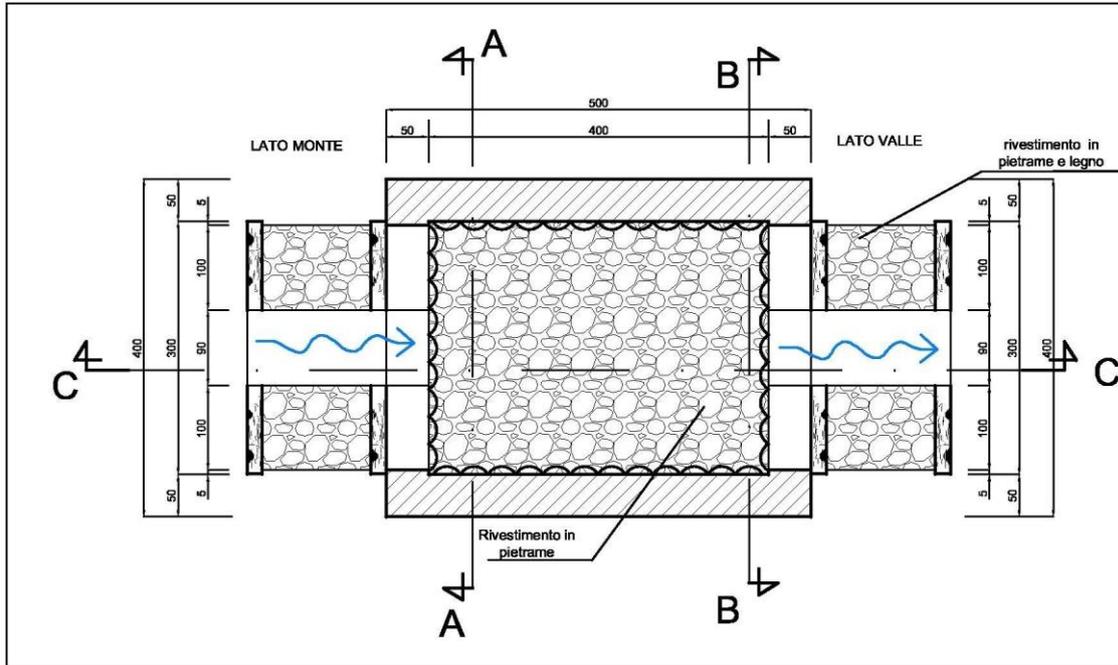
Compluvio nord – Vasche tipo Vn1-Vn8 - pianta
